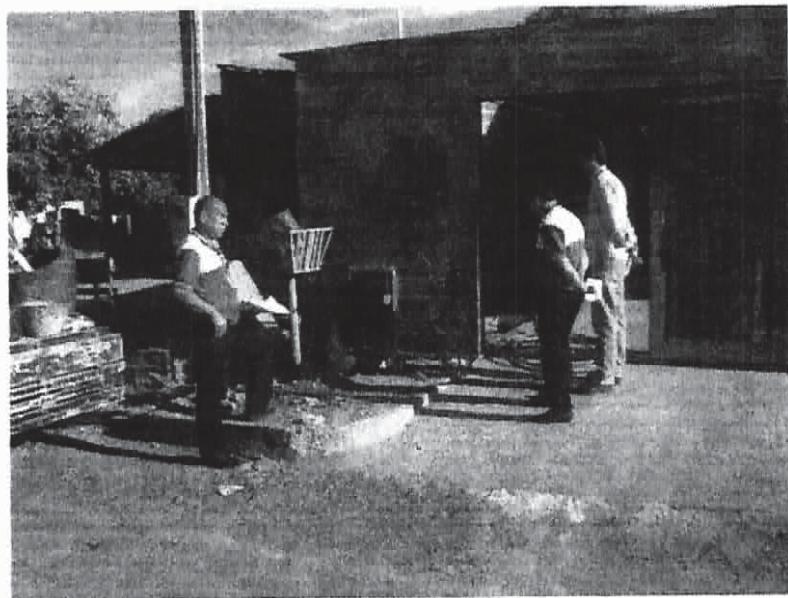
Equipe da ATR com equipe da Saneatins acompanhando ligação em caixa em Gurupi -TO
